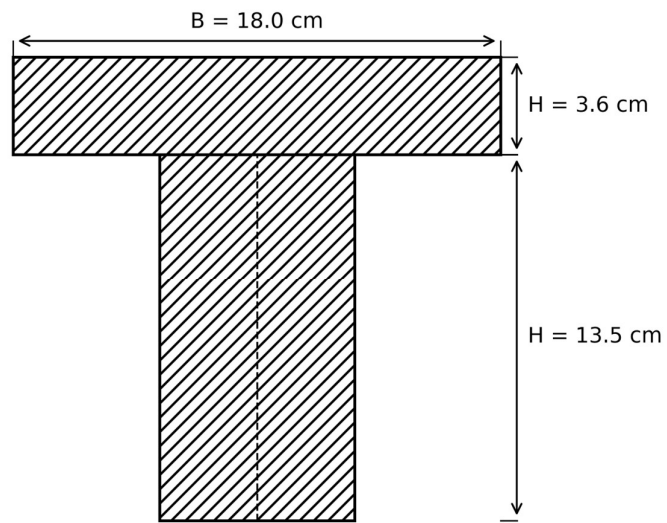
Sección geométrica de viga inclinada de cubierta
